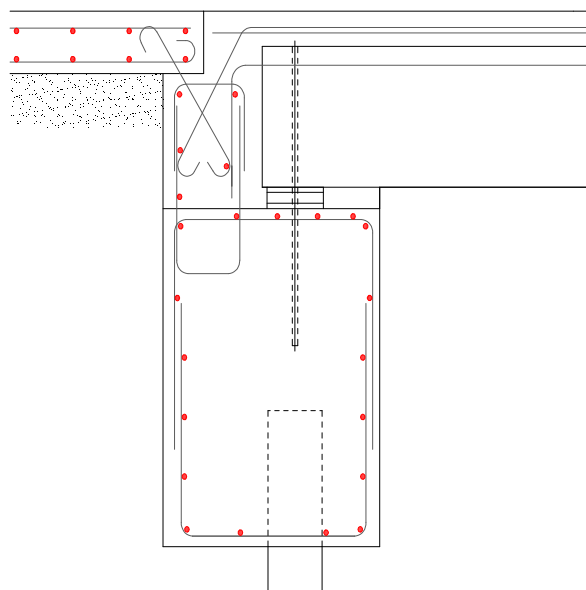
New York State detail for integral abutments, with prestressed concrete girders (Kunin, Alampalli, 1999)
